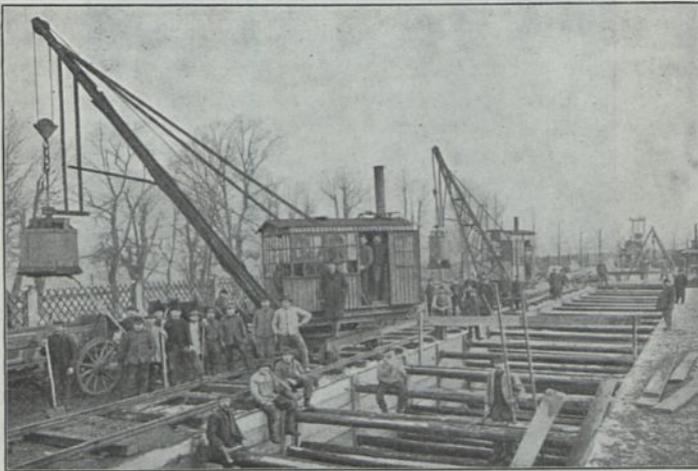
5 m breite offene Baugrube eines Dresdner Hauptkanals (Abfangkanal).
